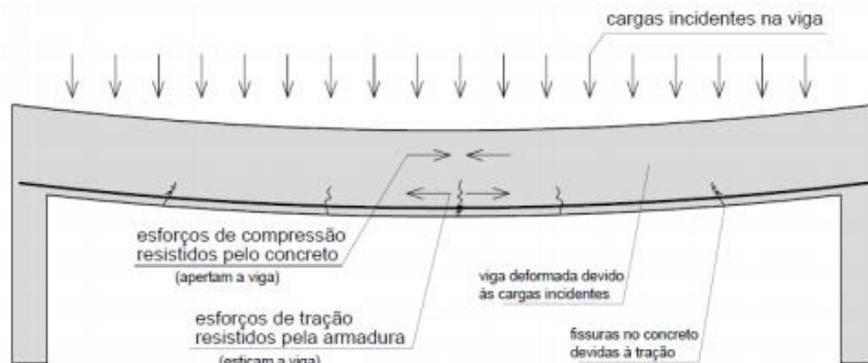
Efeitos de cargas excessivas em estruturas de concreto bi apoiadas [5].
